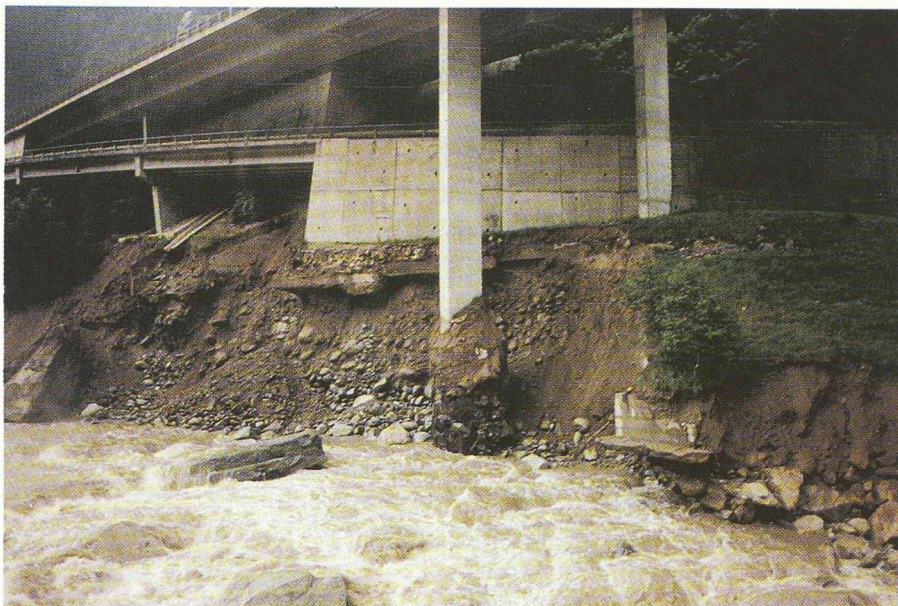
Affaissement du pont sur la Reuss et mise à nu des fondations de la pile J et du mur de soutènement de la route cantonale. (Photo: T. R. Schneider.)
